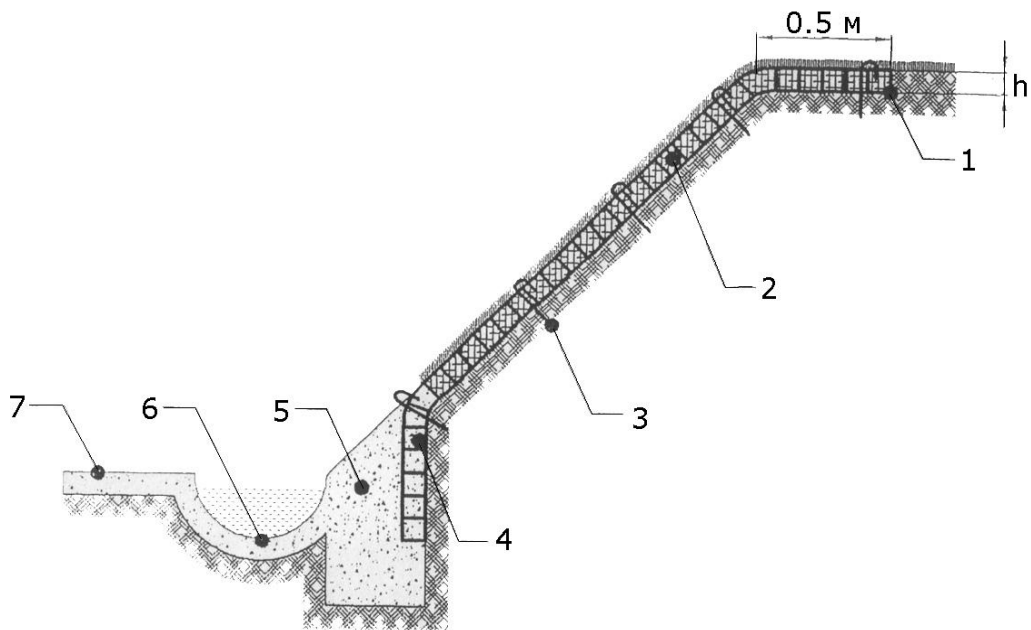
Конструкция укрепления откоса. 1- Геомат; 2 – растительный грунт; 3 – монтажные и несущие нагели; 4 – бетон или щебень; 5 – бетонный упор; 6 – водооточный лоток; 7 – дорога.
